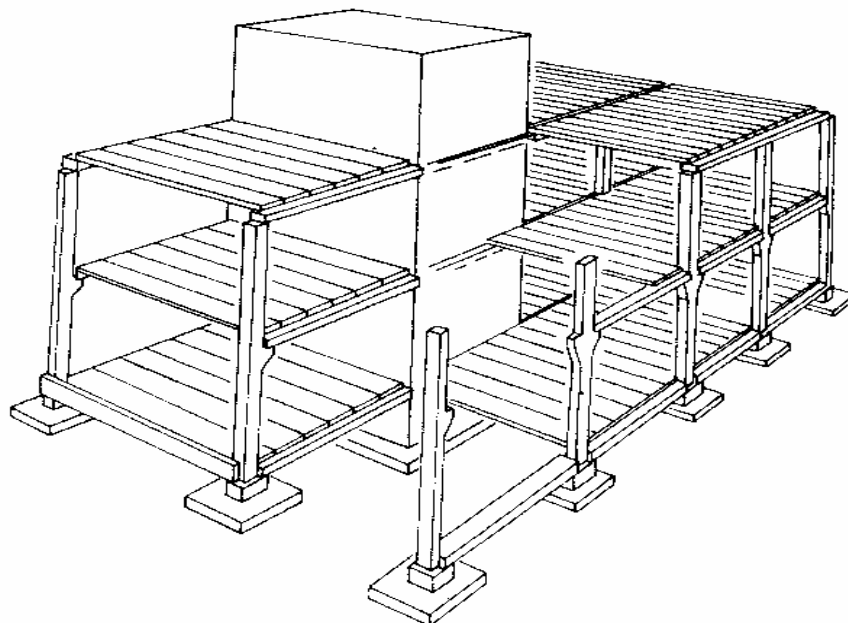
Estructura prefabricada típica con núcleo rígido central.
